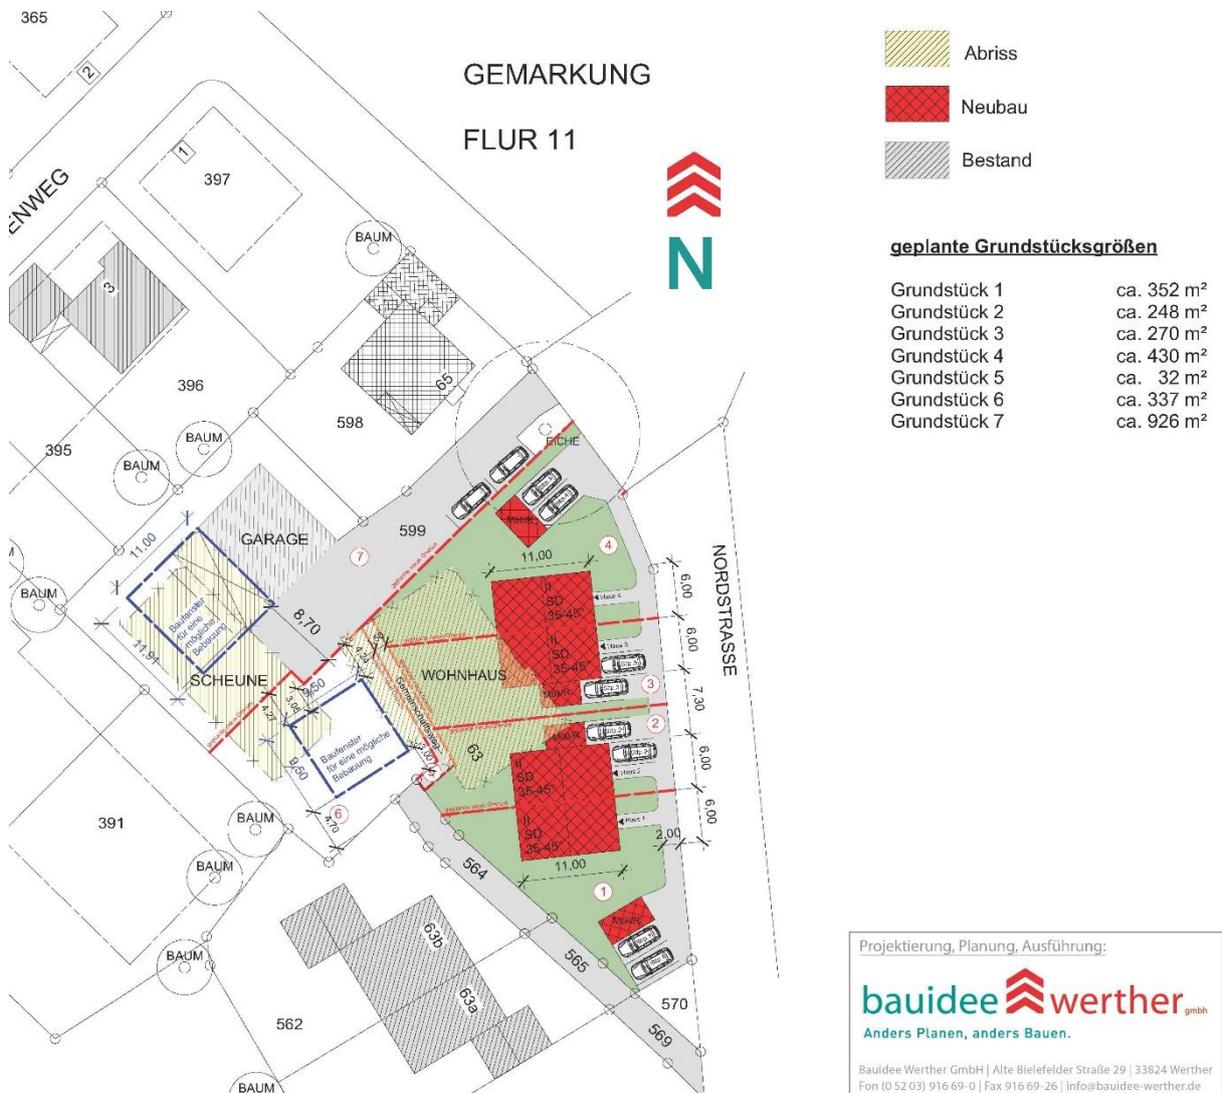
Lageplan zur gestellten Bauvoranfrage auf der ehemaligen Hofstelle (ohne Maßstab), Quelle: Bauidee Werther GmbH
